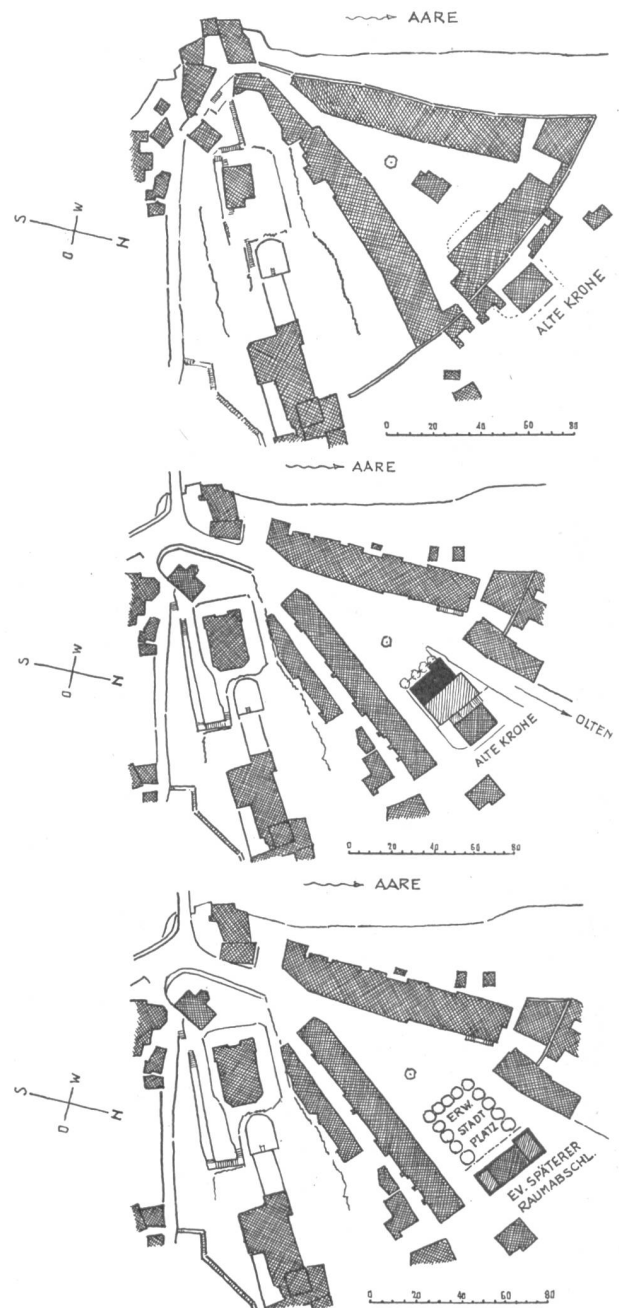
bis 3. *Oben:* Stadtgrundriss vor dem Brand von 1840. Auch gegen Nordwesten war der Stadtraum ursprünglich durch eine Häuserzeile geschlossen. Diese ist nach dem Brand nicht wieder aufgebaut worden, sondern die Kellerdecken wurden mit Erde überdeckt und Bäume gepflanzt. Der Gasthof zur alten Krone stand ausserhalb des Stadtringes. — *Mitte:* Stadtgrundriss 1956. Anstelle der mittelalterlichen, nicht mehr wieder aufgebauten Häuserzeile ist ein dreigeschossiger Neubau projektiert, wobei zwischen diesem Bau und der alten Krone ein eingeschossiger Verbindungsbau vorgesehen ist. Dem Neubau vorgelagert liegt, leicht überhöht, der sogenannte Städtliplatz (Tänzi), bepflanzt mit sieben Linden, die praktisch dem Neubau ebenfalls hätten weichen müssen. — *Unten:* Stadtgrundriss mit erweitertem Stadtplatz. Der in letzter Minute getätigte Landkauf ermöglicht eine Vergrößerung des Platzes. Gleichzeitig wird für die Liegenschaften der beiden andern Platzwände eine bedeutende Verbesserung der Besonnung und Belichtung erreicht. Später einmal kann der räumlich erwünschte Abschluss des erweiterten Stadtraumes gegen Nordwesten verwirklicht werden, da sich die Gemeinde das Recht für den Erwerb der alten Krone ebenfalls gesichert hat.
